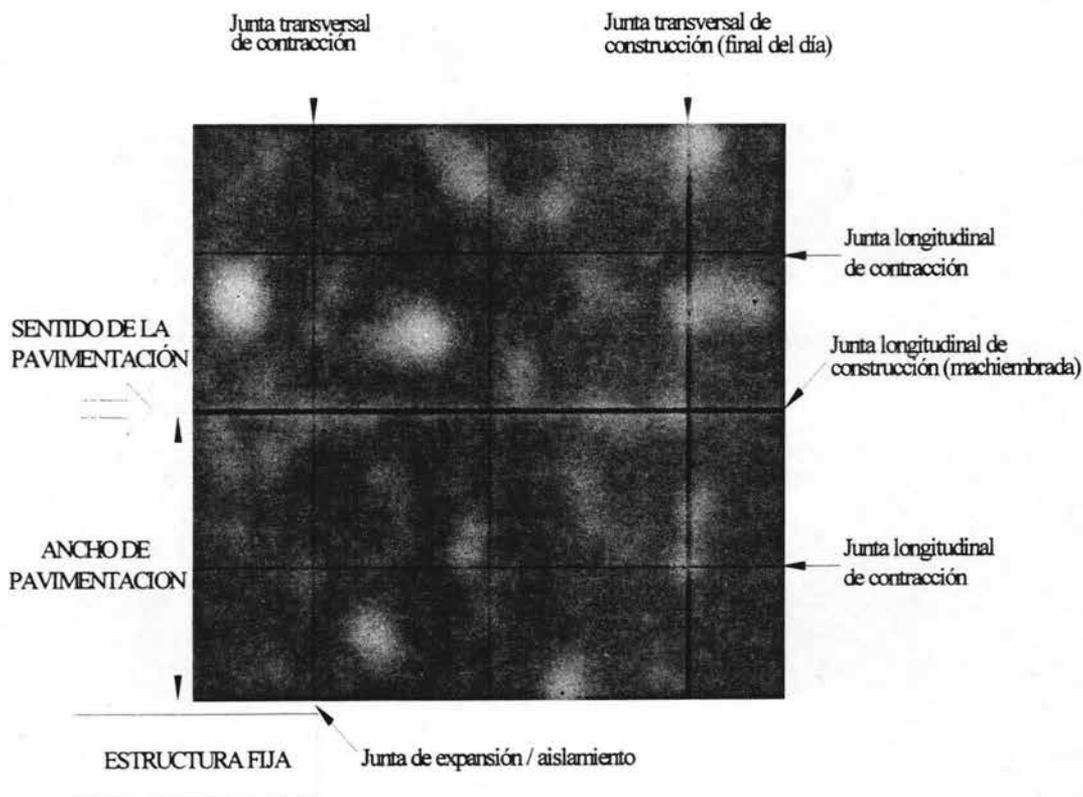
Croquis de los tipos de juntas en un pavimento de concreto
